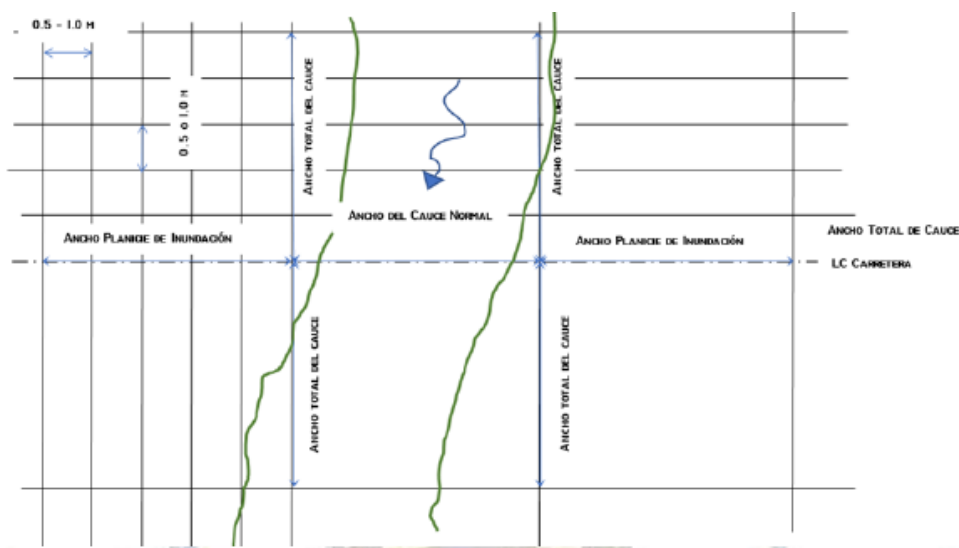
Levantamiento topográfico de una sección típica del cauce en planta.
